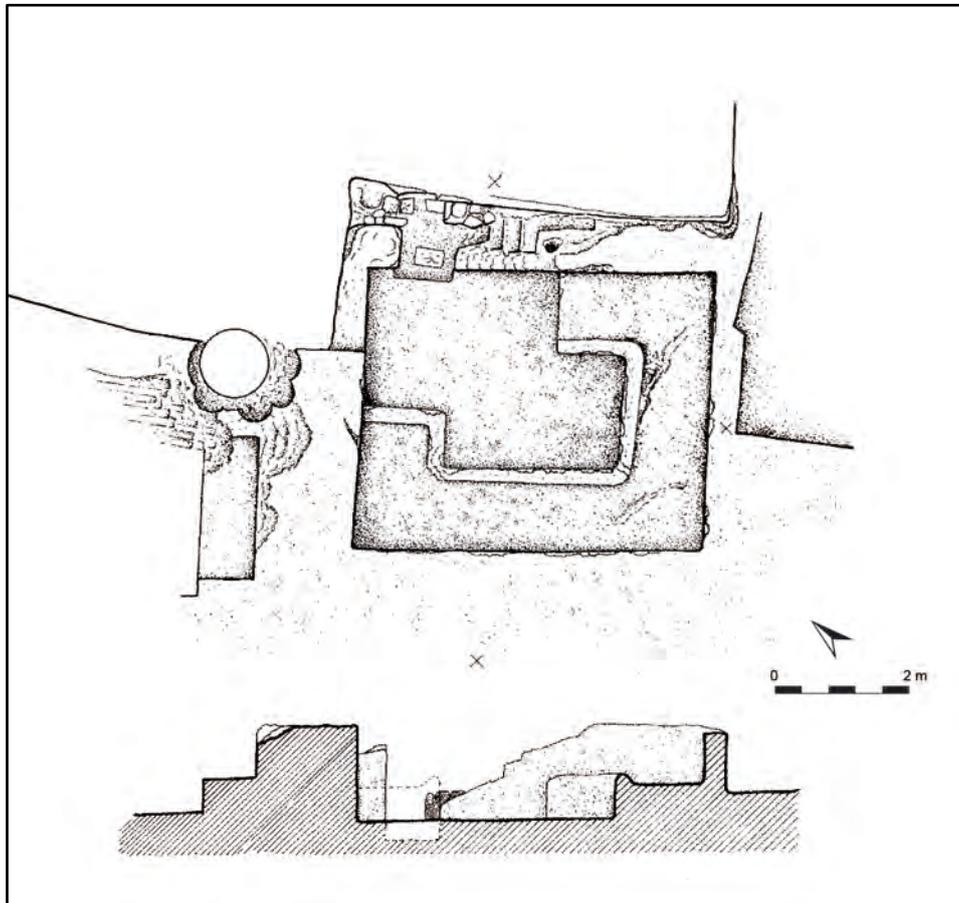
Necropoli di Gabbari, Alessandria. Planimetria del divano da banchetto.
